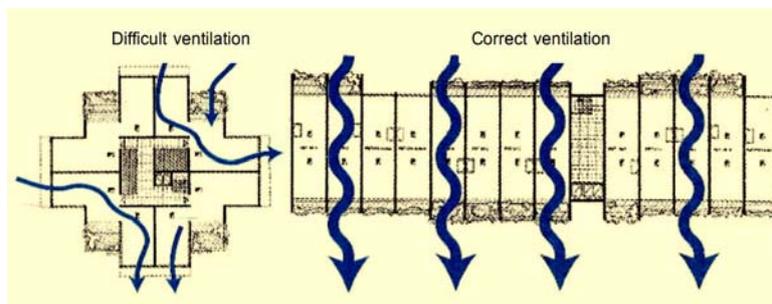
A ventilação natural depende da configuração do edifício. Os locais que disponham de pelo menos duas aberturas exteriores, em fachadas opostas, permitem uma boa ventilação (adaptado de AAVV, 2002).
